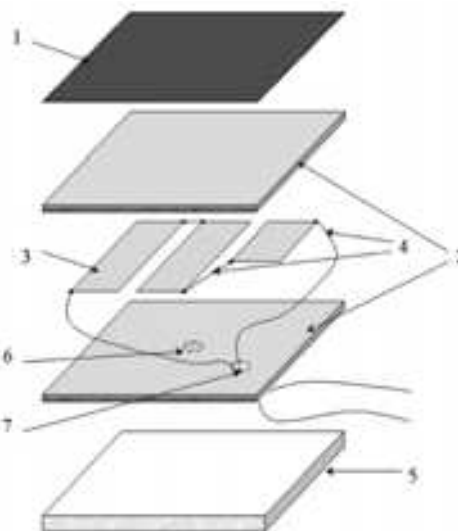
Конструкция греющей опалубки: 1 – защитное, износостойкое, влагостойкое покрытие; 2 – влагостойкая фанера 9 мм; 3 – ленточный нагреватель; 4 – соединительные провода; 5 – теплоизолятор; 6 – выборка под установку термодатчика; 7 – выводное отверстие
